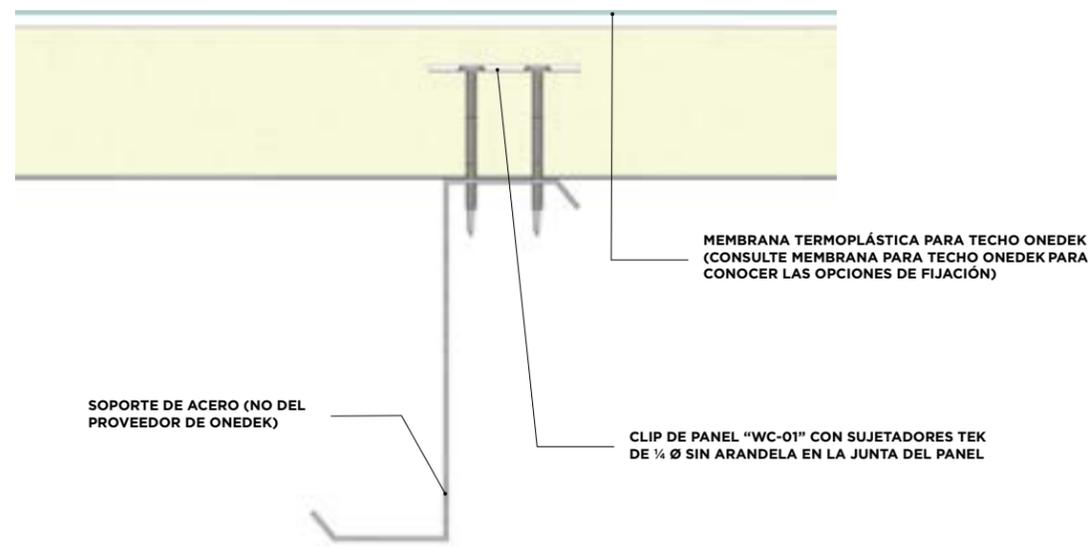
FIJACIÓN INTERMEDIA AL TEJADO RD1/RD1-M (VISTA DE LA SECCIÓN)
